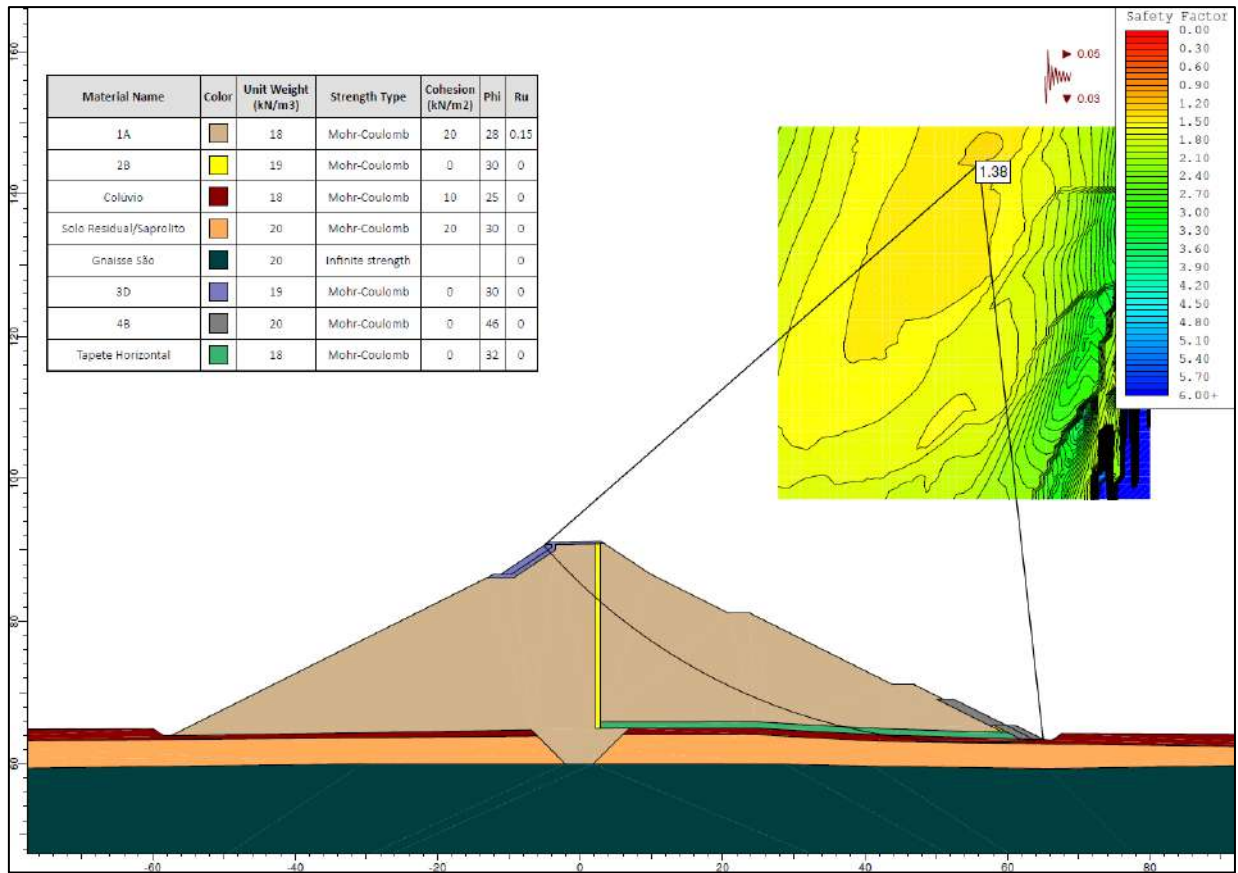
Seção Típica Est. 25+2,20 a 37+10,00 – Final de Construção Jusante – Com Sismo
